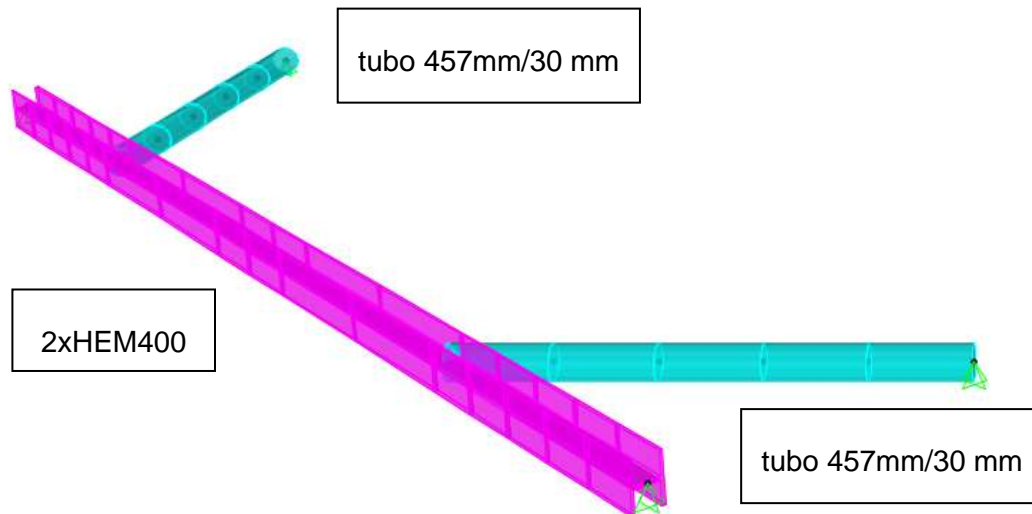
Telaio metallico SAP2000 – Schema statico e sezioni
